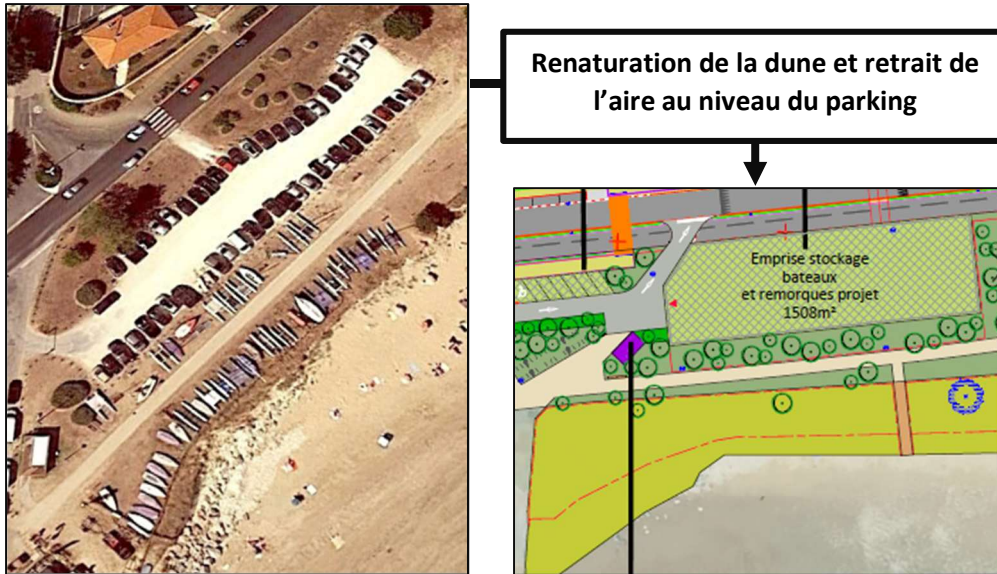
Retrait de l'aire de stockage des bateaux par rapport à la dune et implantation au droit d'un ancien parking
